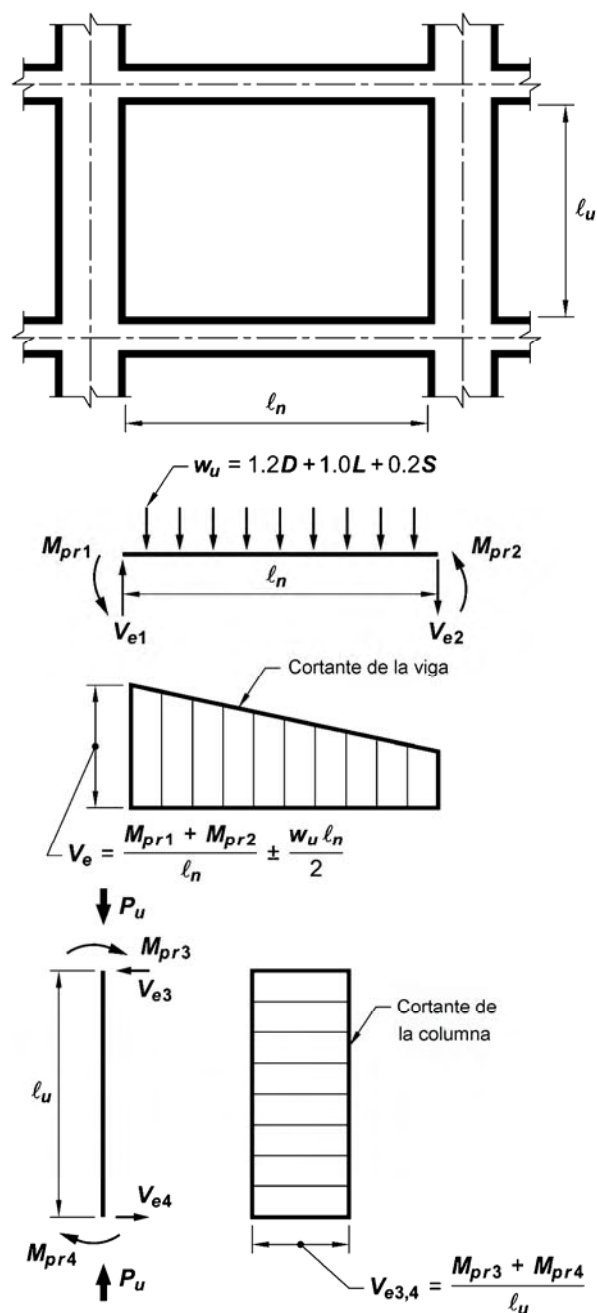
Cortante de diseño para vigas y columnas
